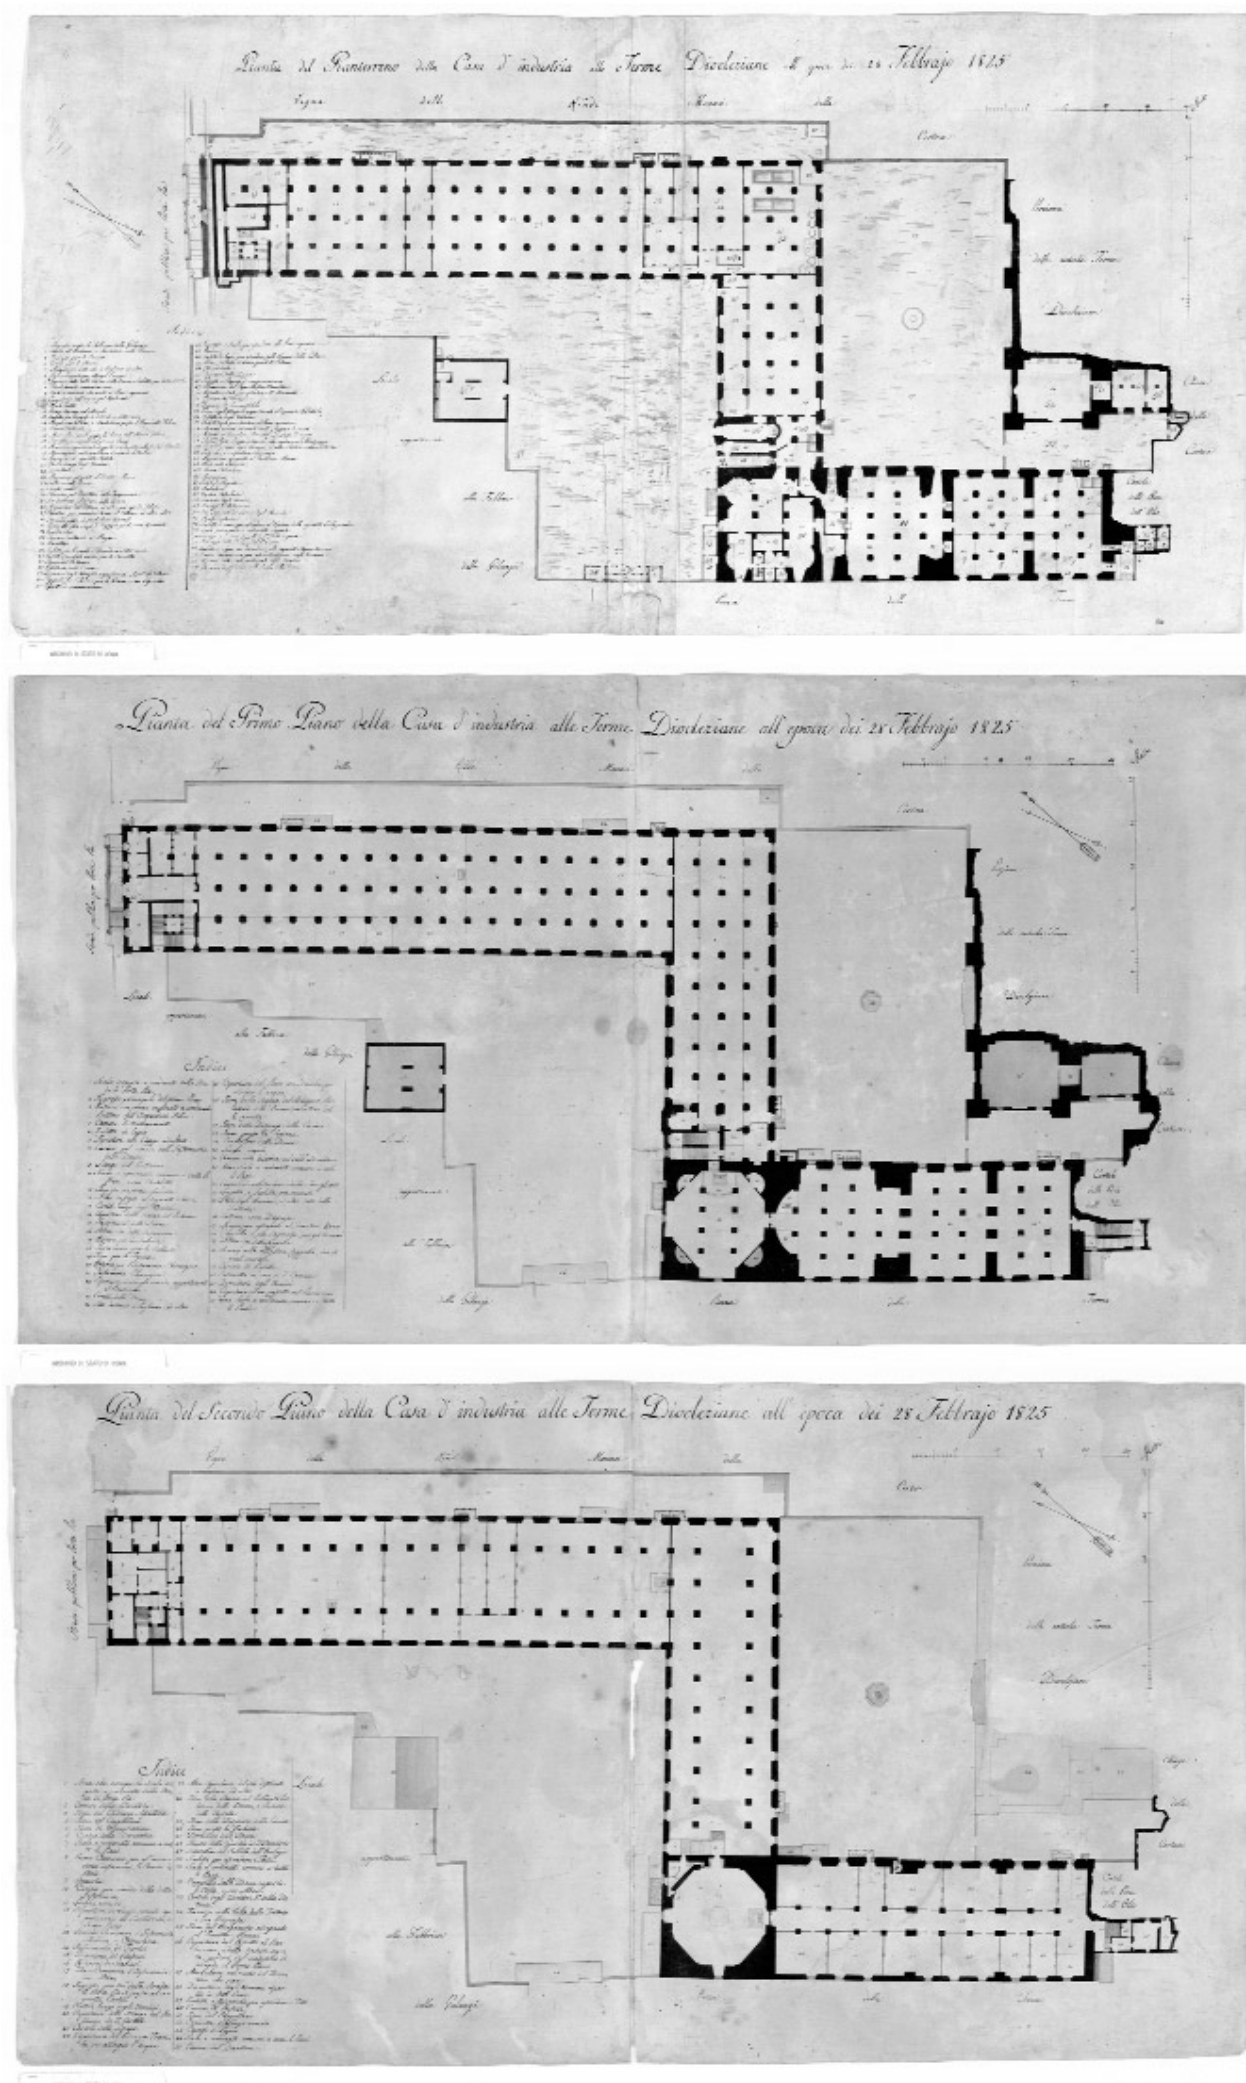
Pianta risalenti al febbraio 1828 dei tre piani dei granai Gregoriano, Paolino e Urbaniano trasformati in orfanotrofio nel 1817 (Archivio di Stato di Roma, Collezione di disegni e piante, III,VI-42, n. 194).
